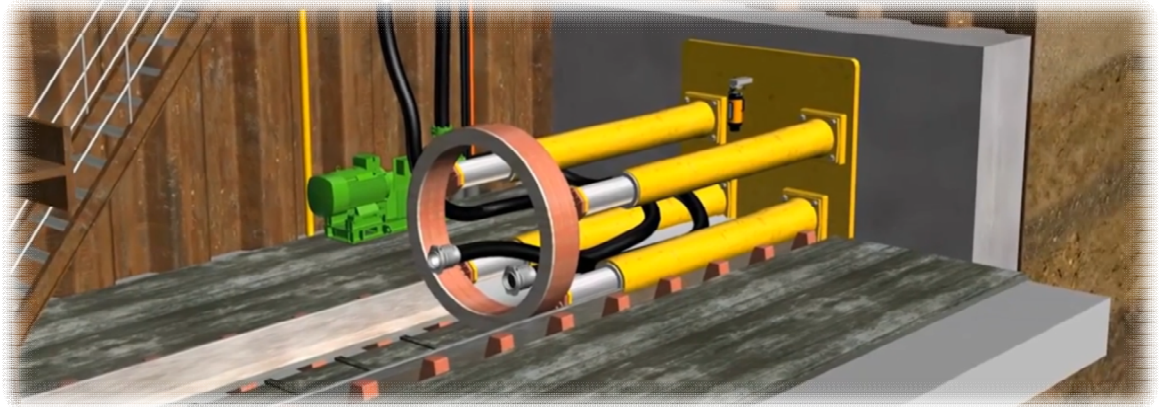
Muro de empuje y equipo de hincado. Herrenknecht 2025.
